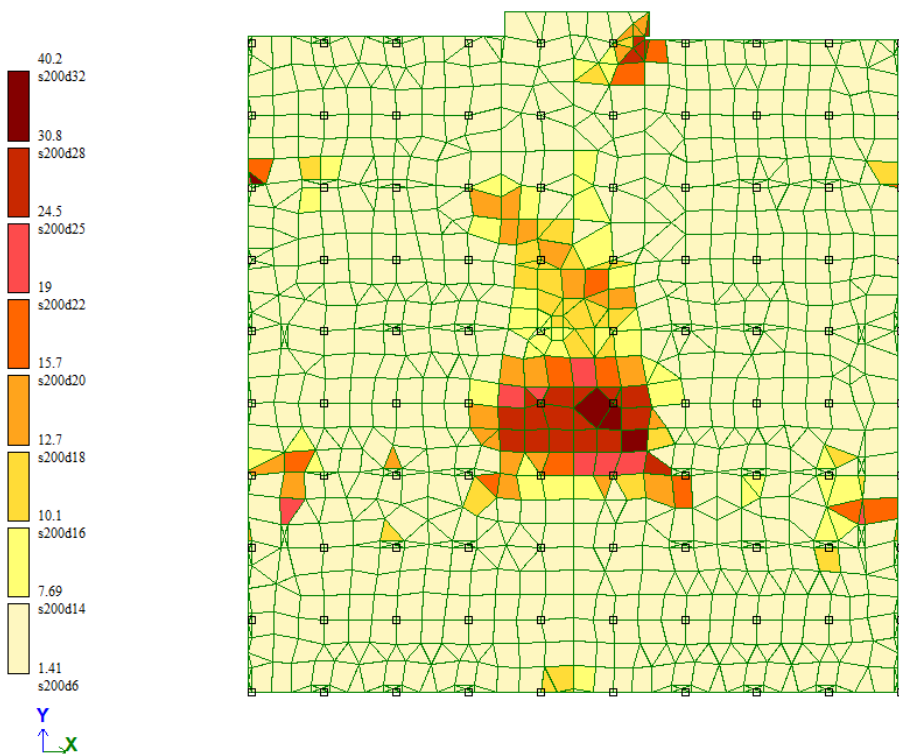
Схема армирования низа фундаментной плиты по оси OY
